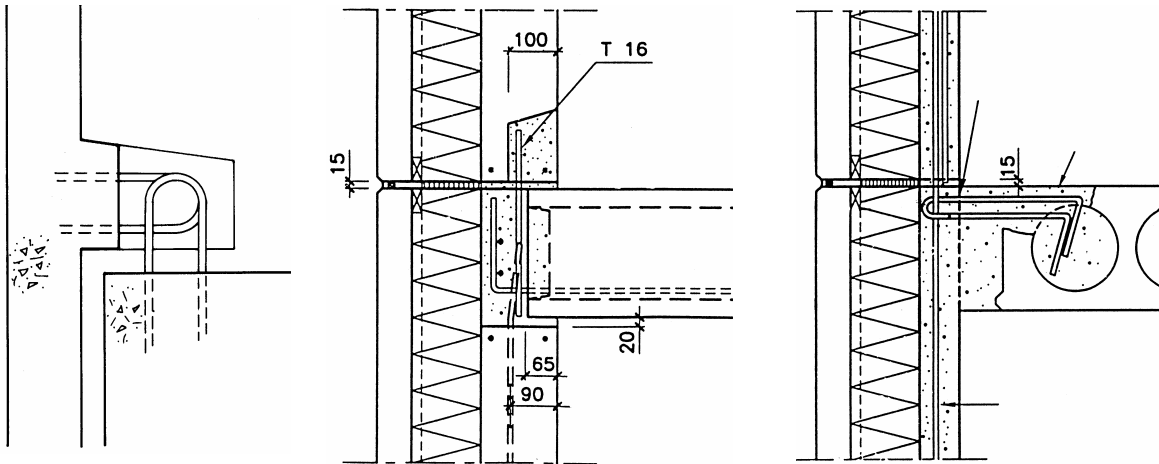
Exemplos de ligações com armaduras de sobreposição e concreto de preenchimento no local
